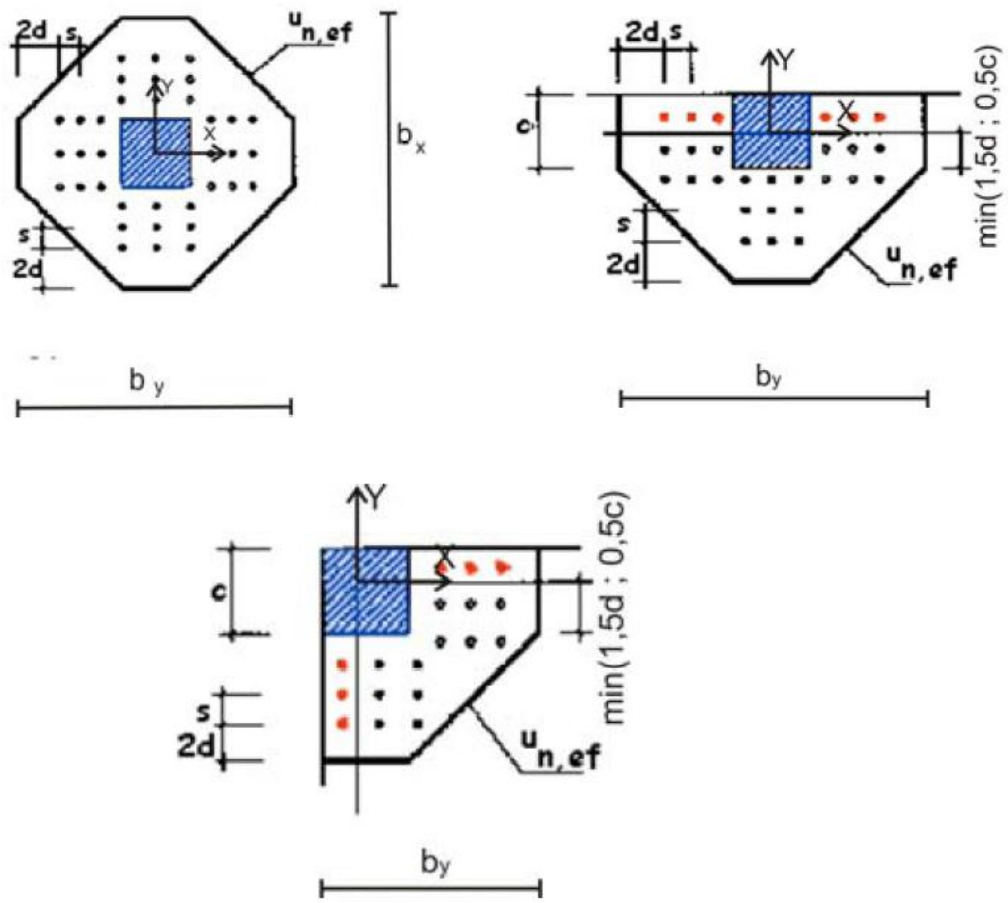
a Planta de tipos de armado de punzonamiento.
